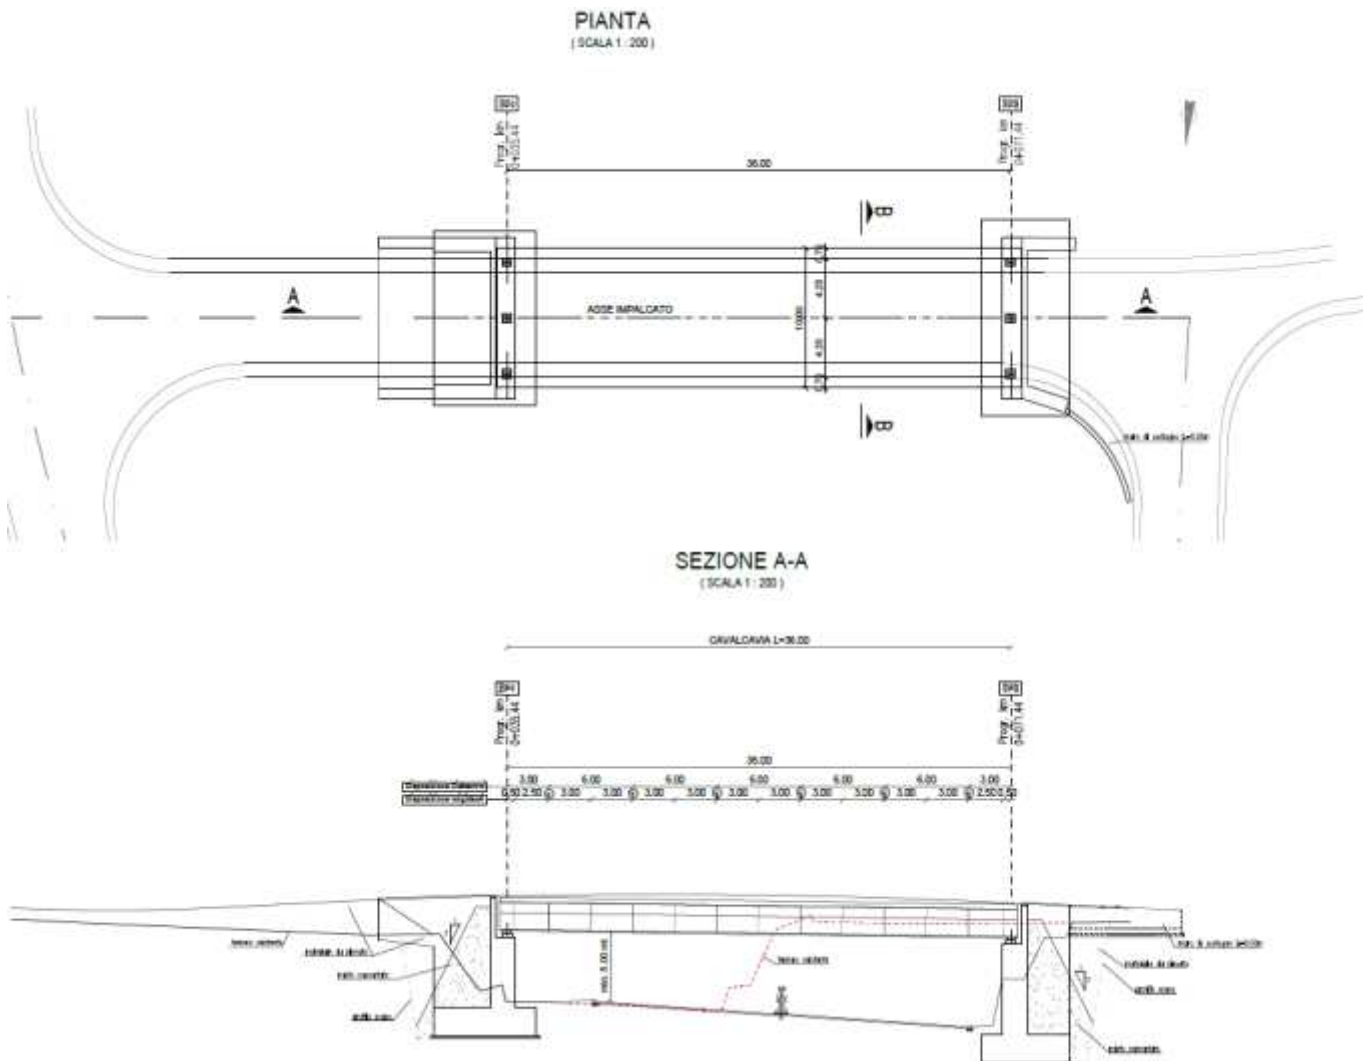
Pianta e Sezione Cavalcavia al Km 1+800
